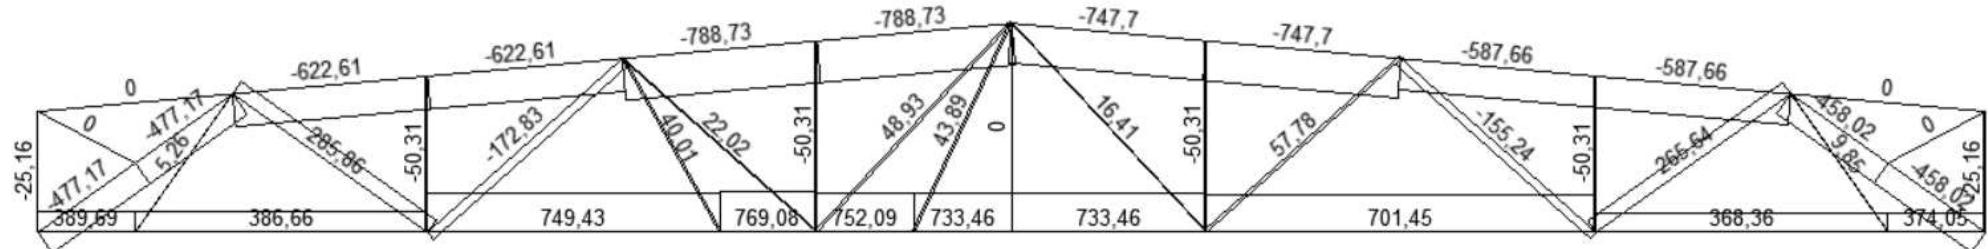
Эпюра внутренних усилий от основного сочетания нагрузок на стропильную ферму
